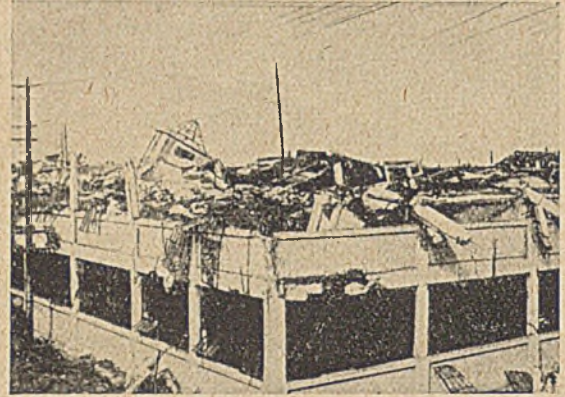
Zerstörte Eisenbetonbauten in Tokio.
